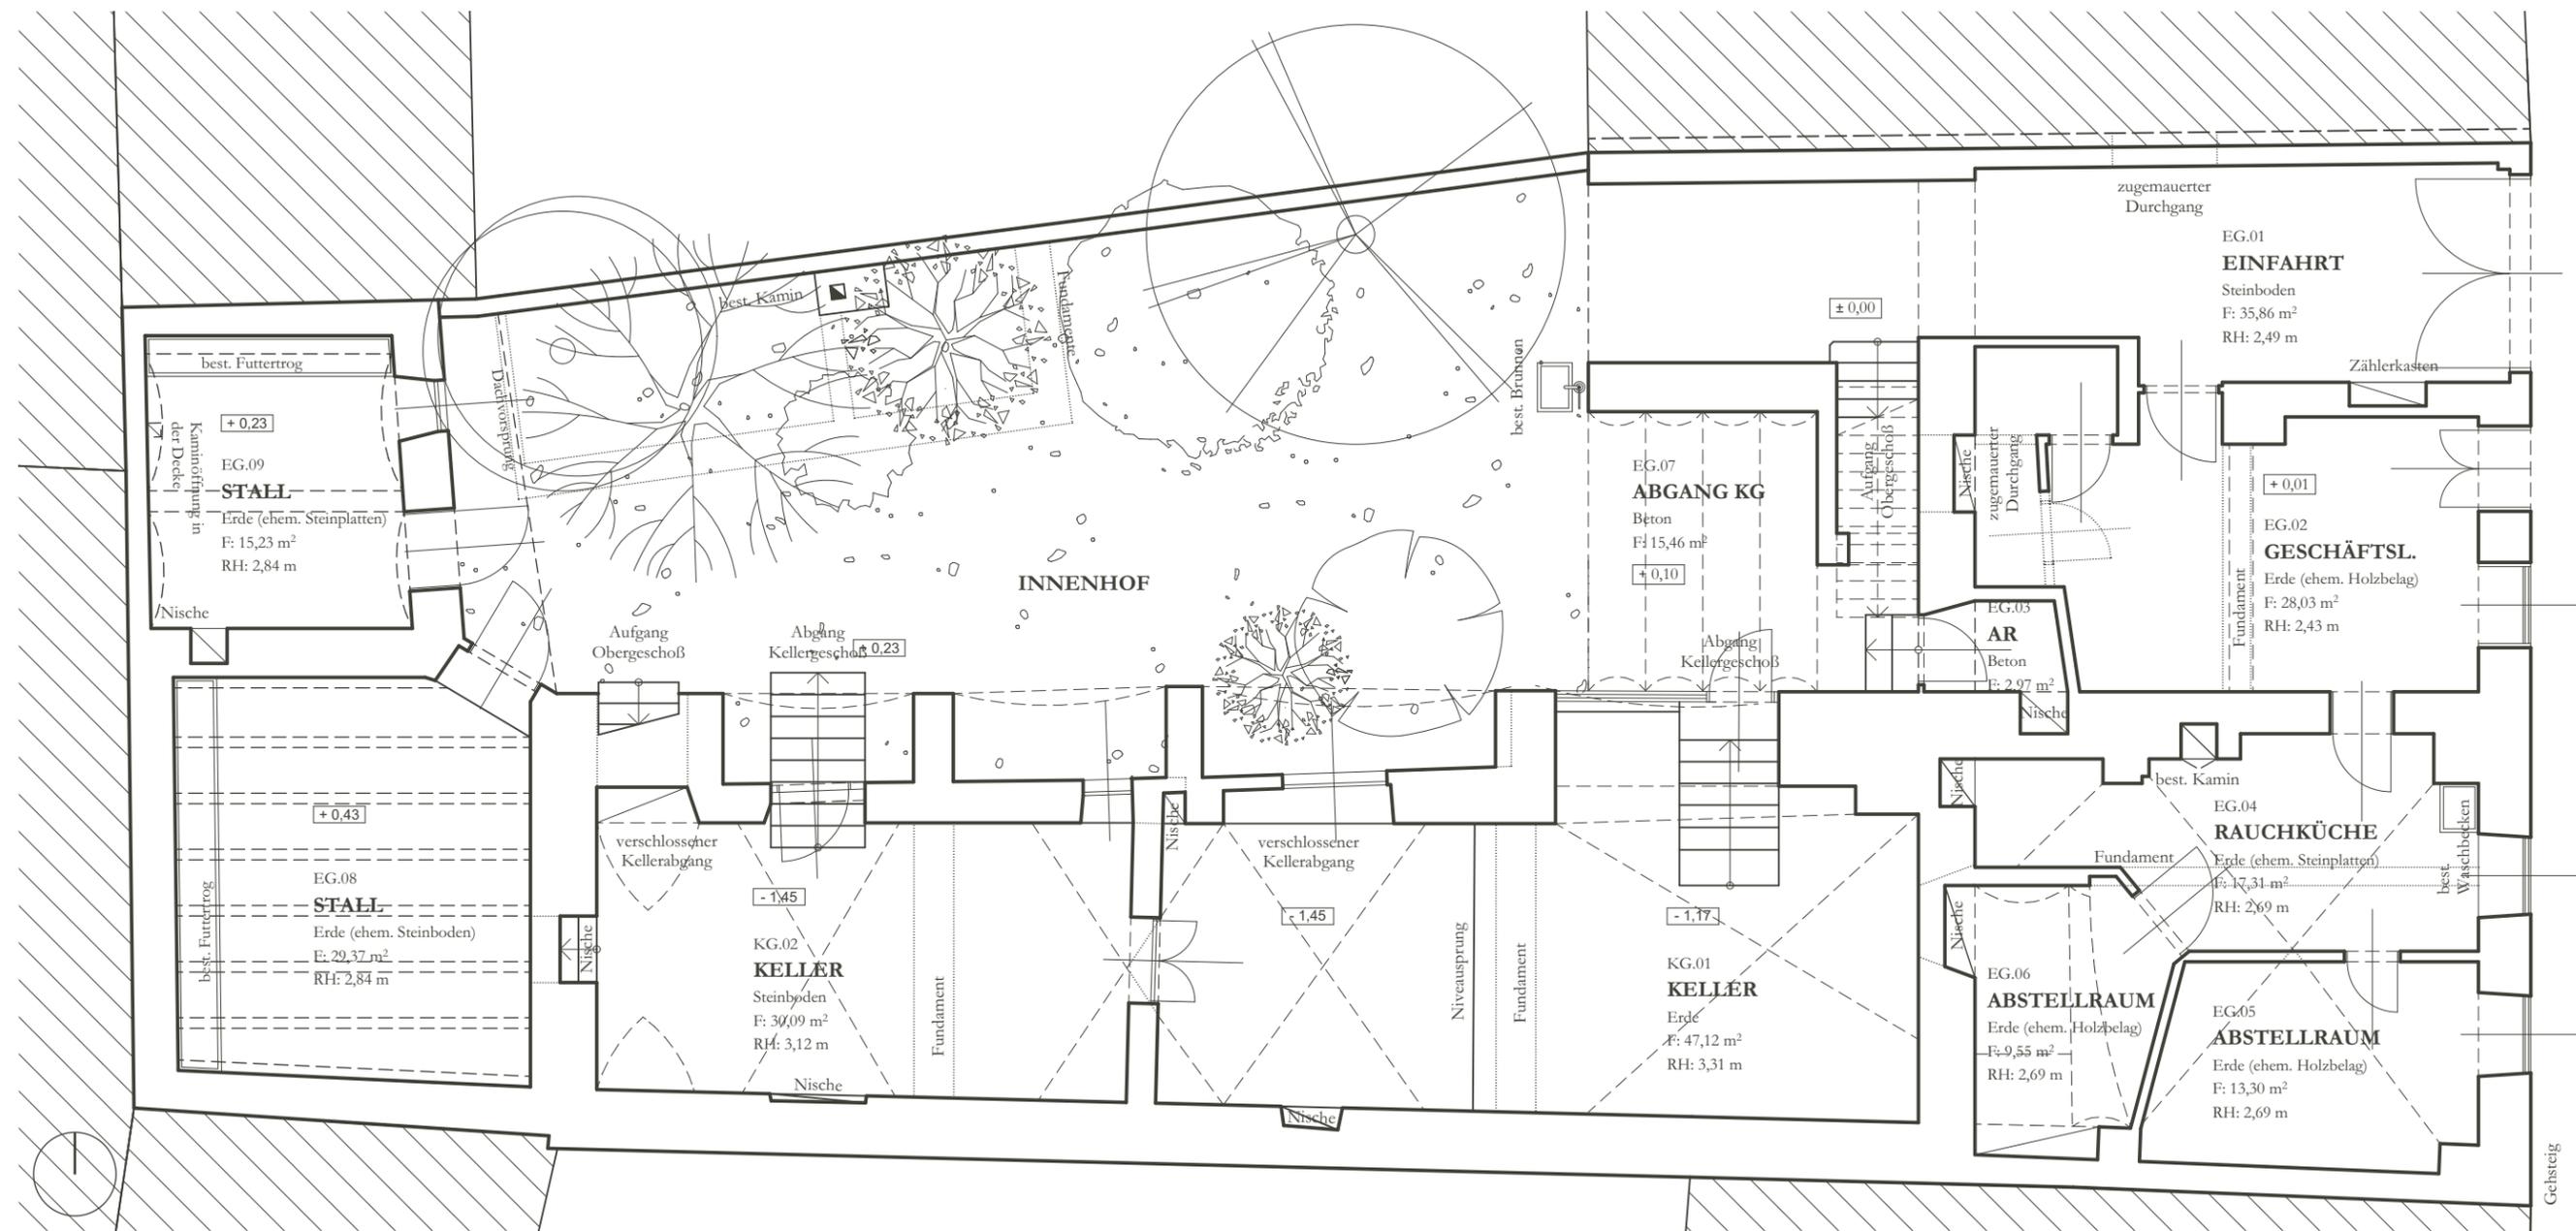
Bestandsplan Erdgeschoss, M 1:100
